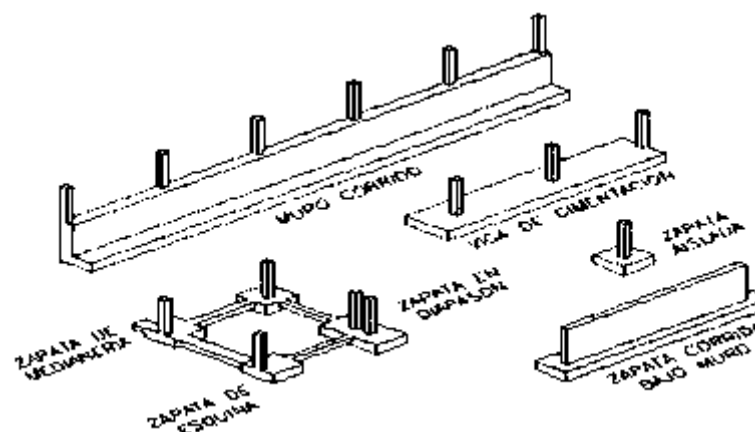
Zapatas aisladas fuente: <http://www.parro.com.ar/definicion-de-zapata> [28-oct-2015]
